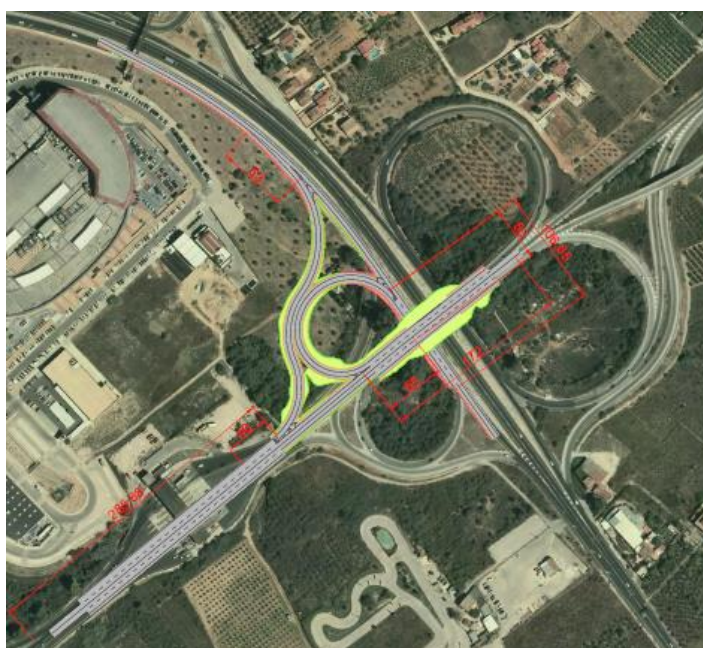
Trazado en planta de la alternativa propuesta. Fuente: elaboración propia.
